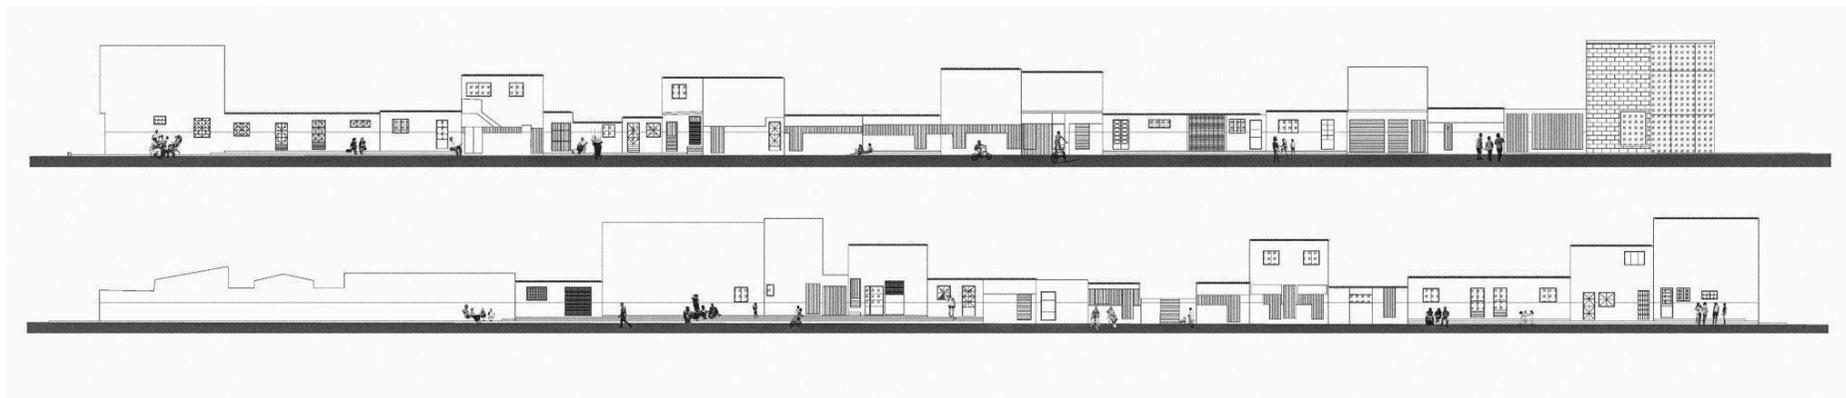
Diagrama em elevação da dimensão espacial dos entrelugares da Rua Santa Sofia.
